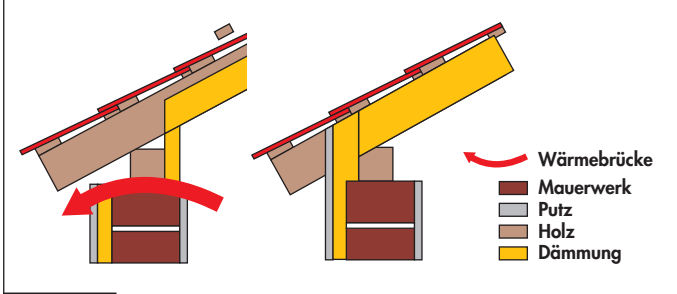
Anschlussdetail mit Wärmebrücke und Möglichkeit zur Behebung
